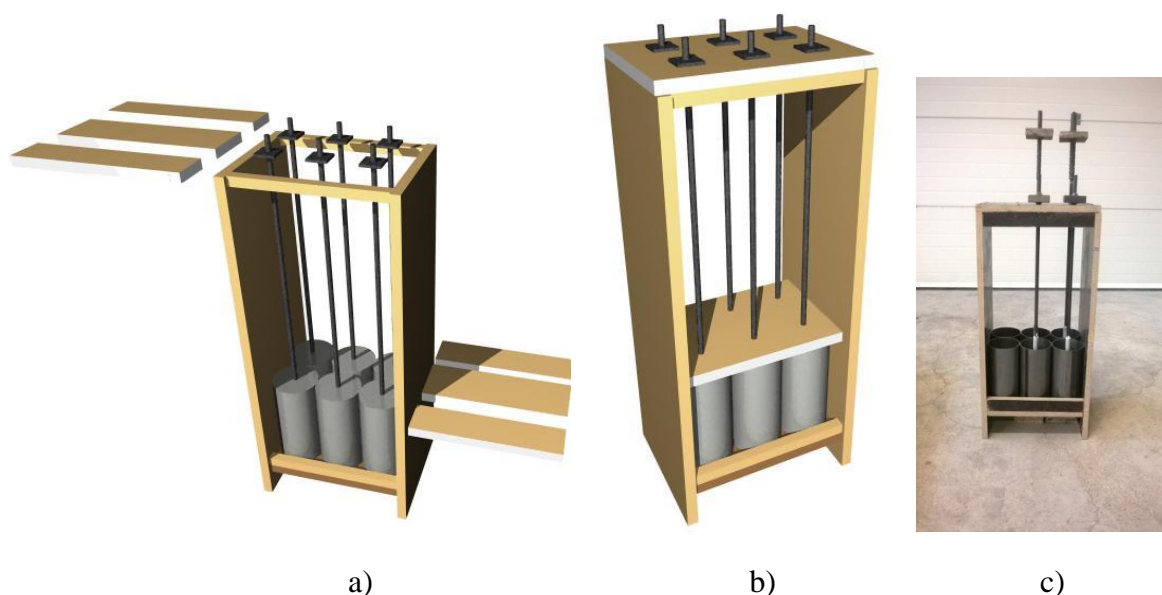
Estrutura de montagem do ensaio *Pull Out* para betonagem: a) projeto 3D da estrutura com os seus elementos; b) Projeto 3D da estrutura montada; c) Estrutura real em utilização.
